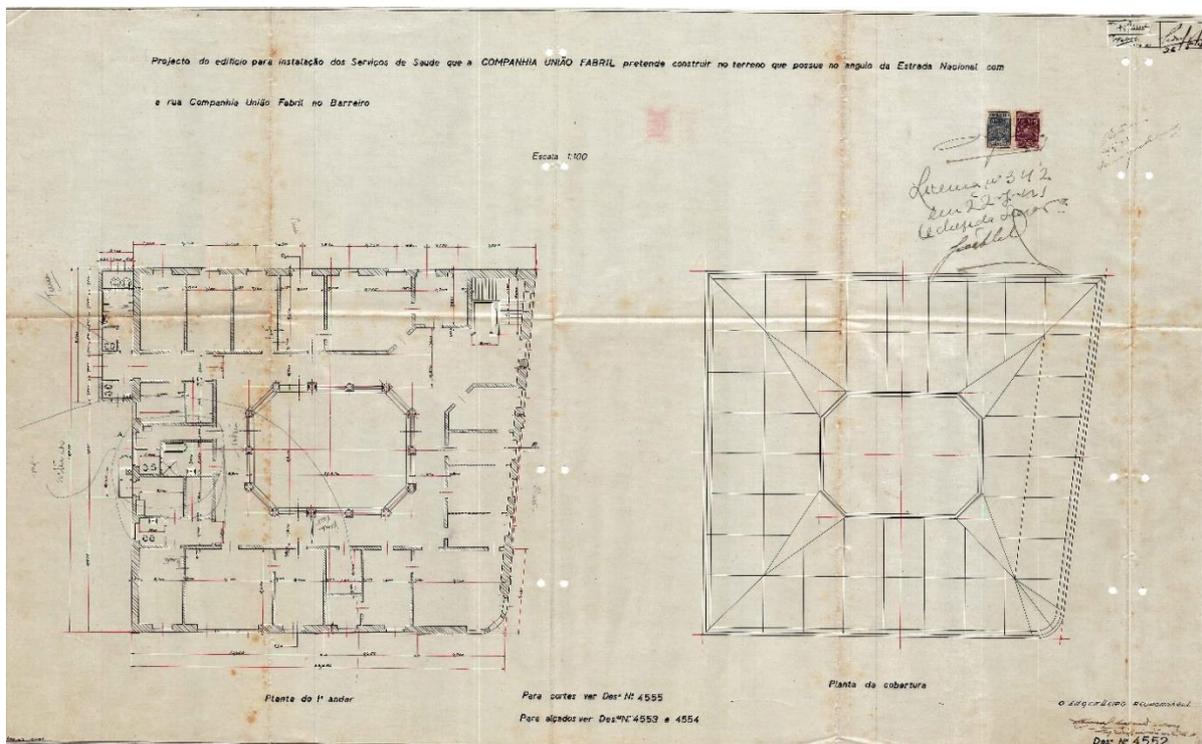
Plantas do 1º andar e da cobertura do edificio para instalação dos Serviços de Saúde
